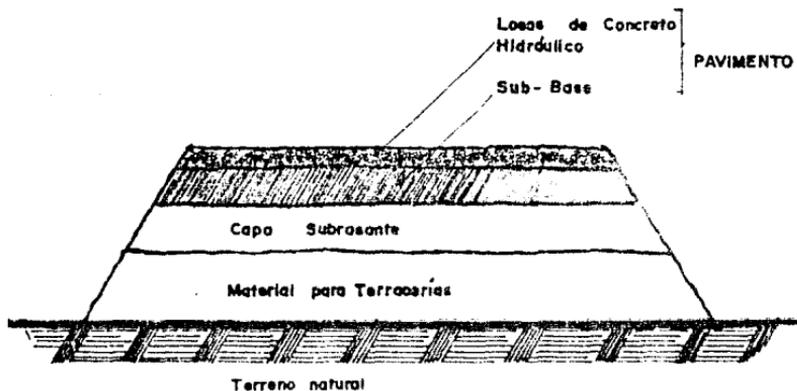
SECCION TIPO DE PAVIMENTO RIGIDO
